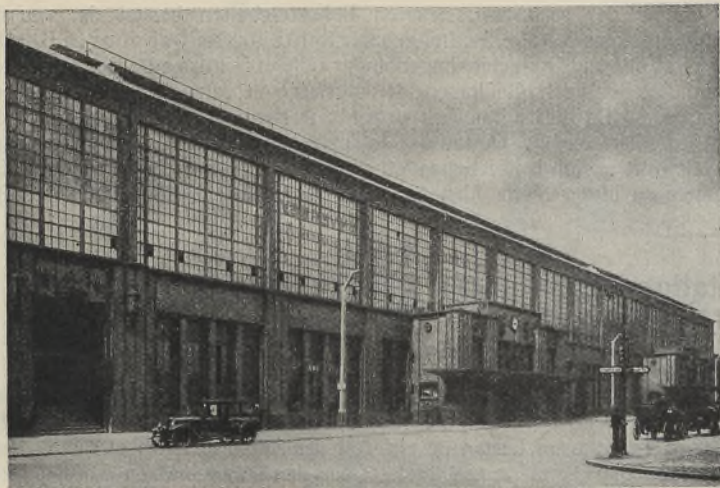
Bahnhof Berlin Friedrichstraße. Äußere Seitenansicht.
